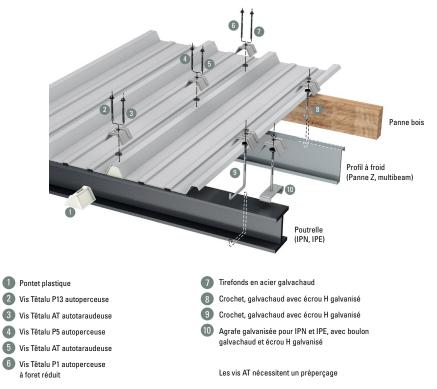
Exemple de fixations sur toiture en tôle d'acier nervurée
